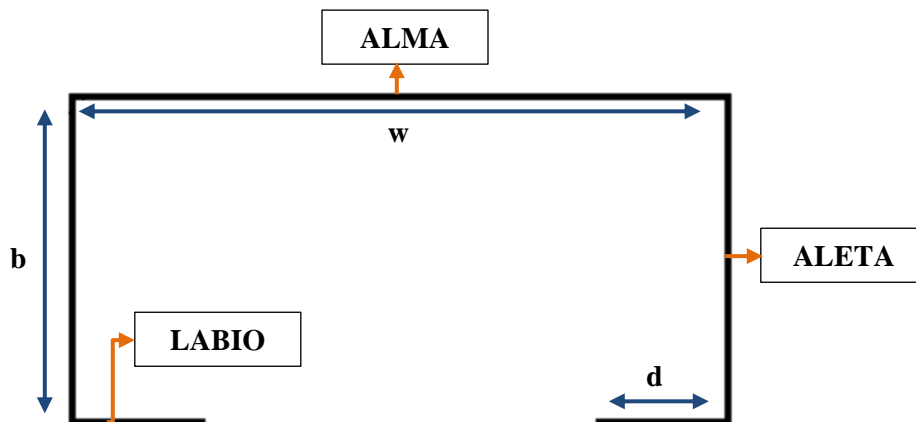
Elementos de perfil tipo canal con labios hacia dentro.
